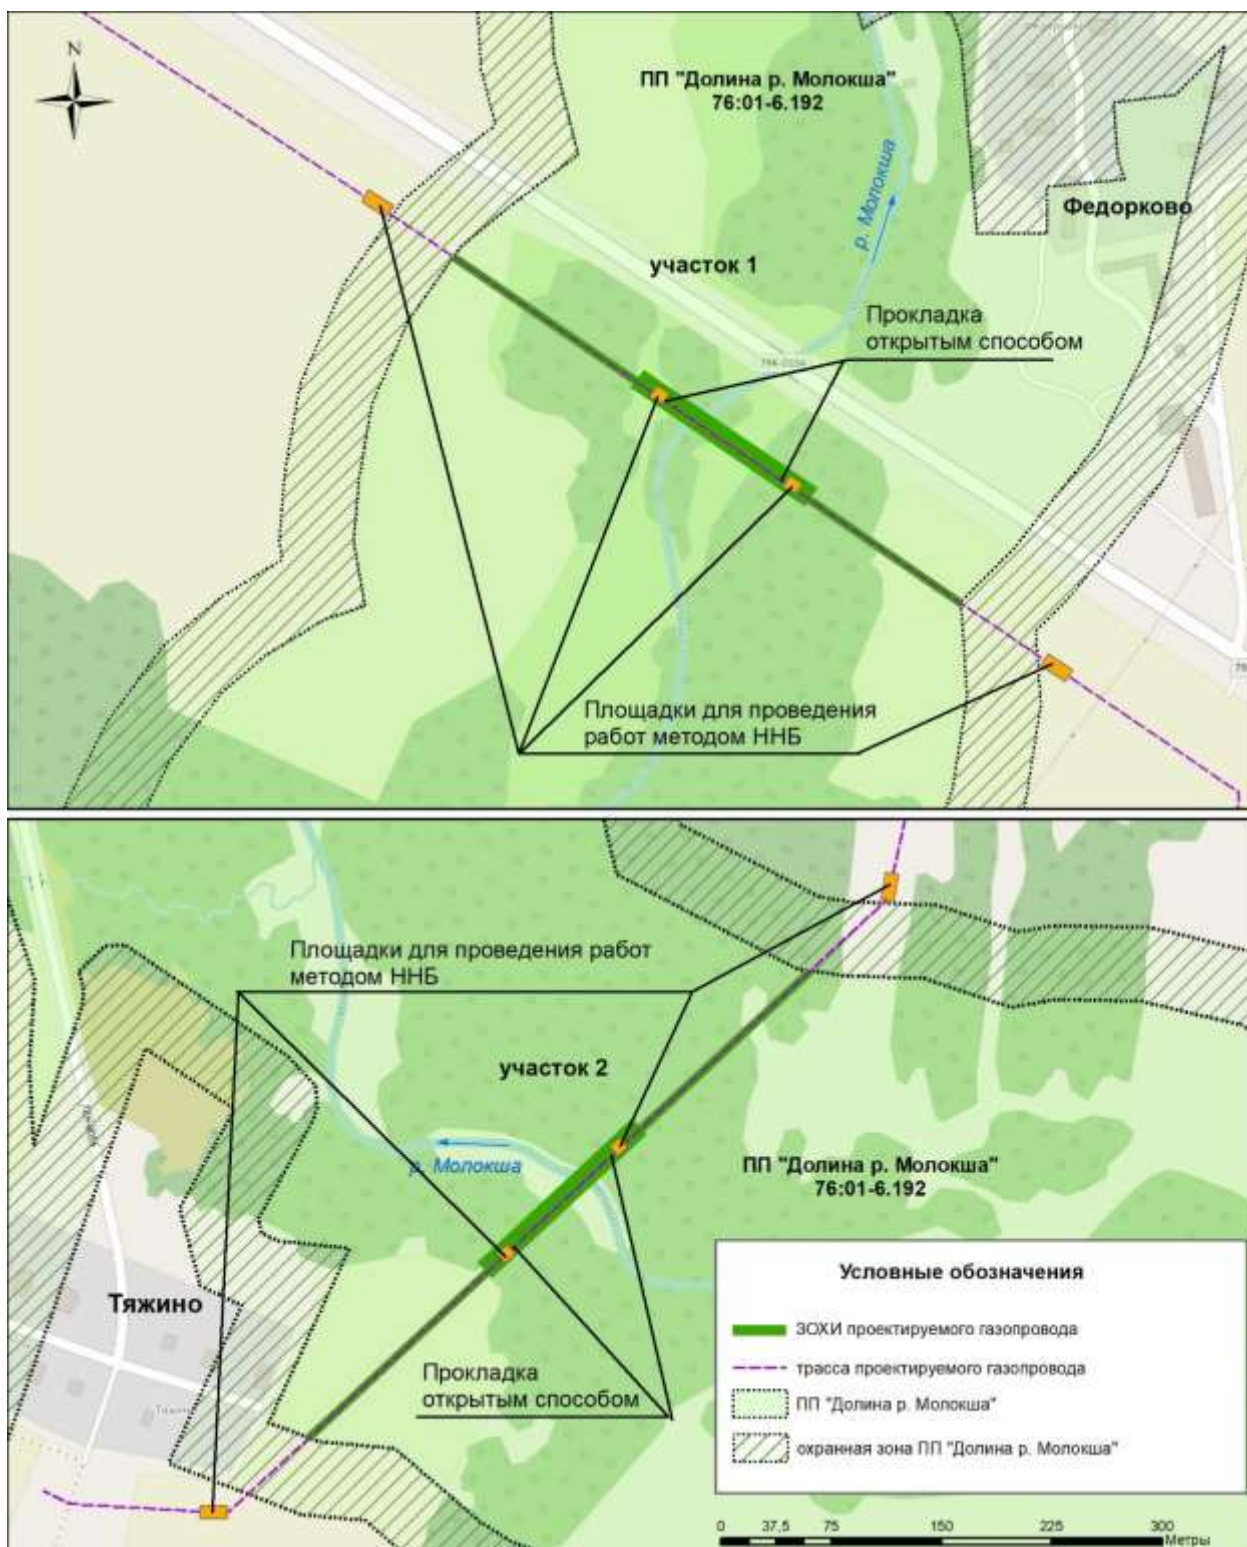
Строительные площадки для проведения работ по выполнению переходов через р. Молокша
